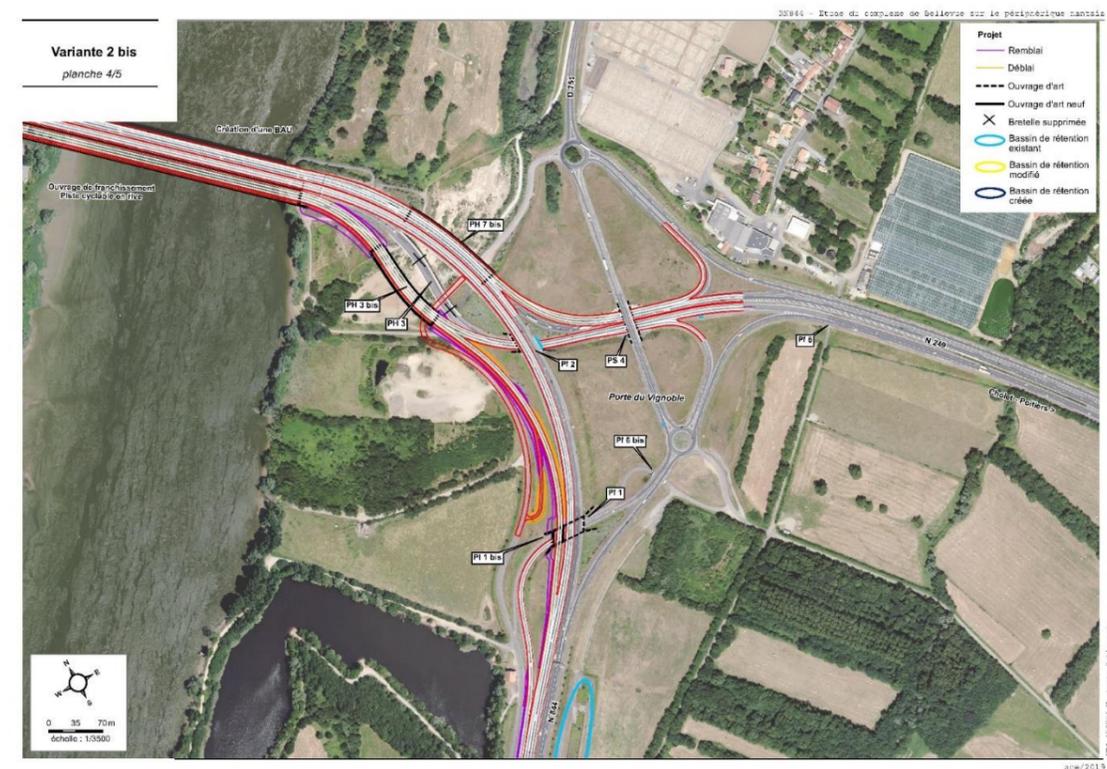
Plan de la variante 2 bis au droit de la Porte du Vignoble
